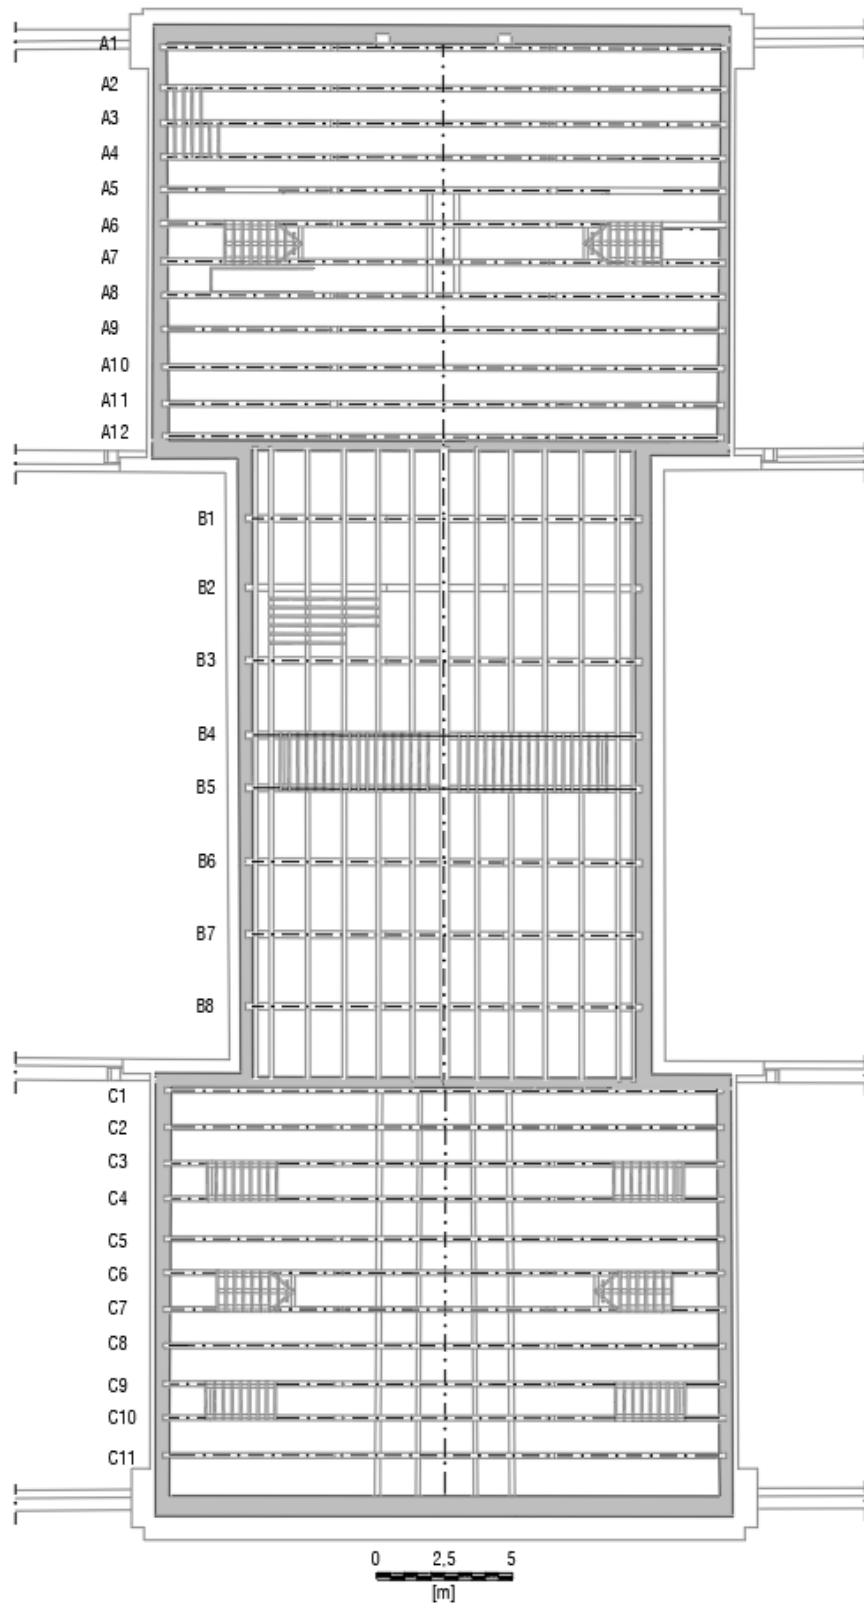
Pianta della copertura del corpo centrale di Villa Pisani – Pianta puntoni.
